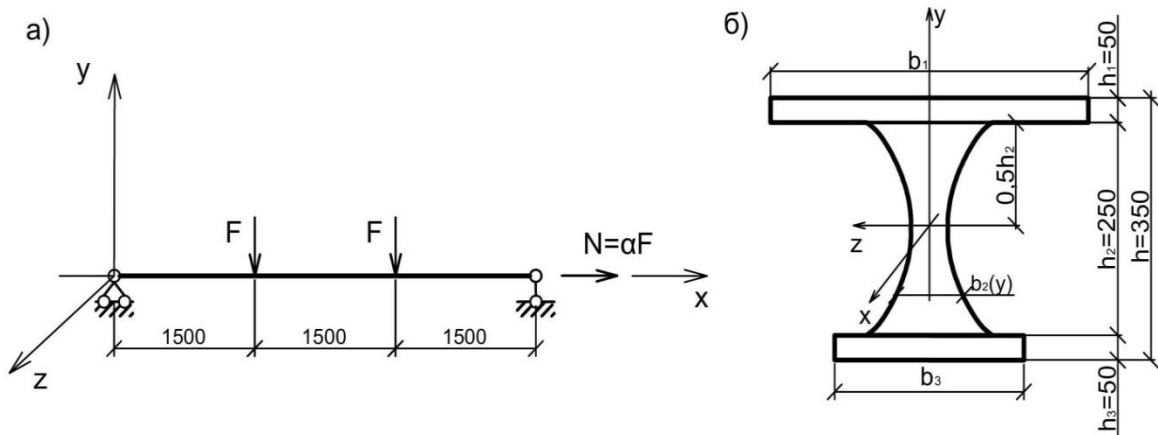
К расчёту деревянной балки: а) расчётная схема балки; б) поперечное сечение балки
